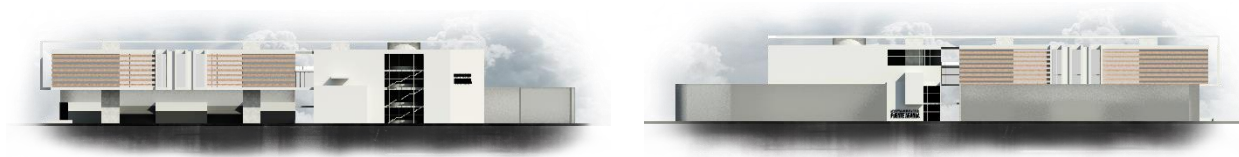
Autor: Elaboración propia. (2018). *Fachadas norte y sur.
